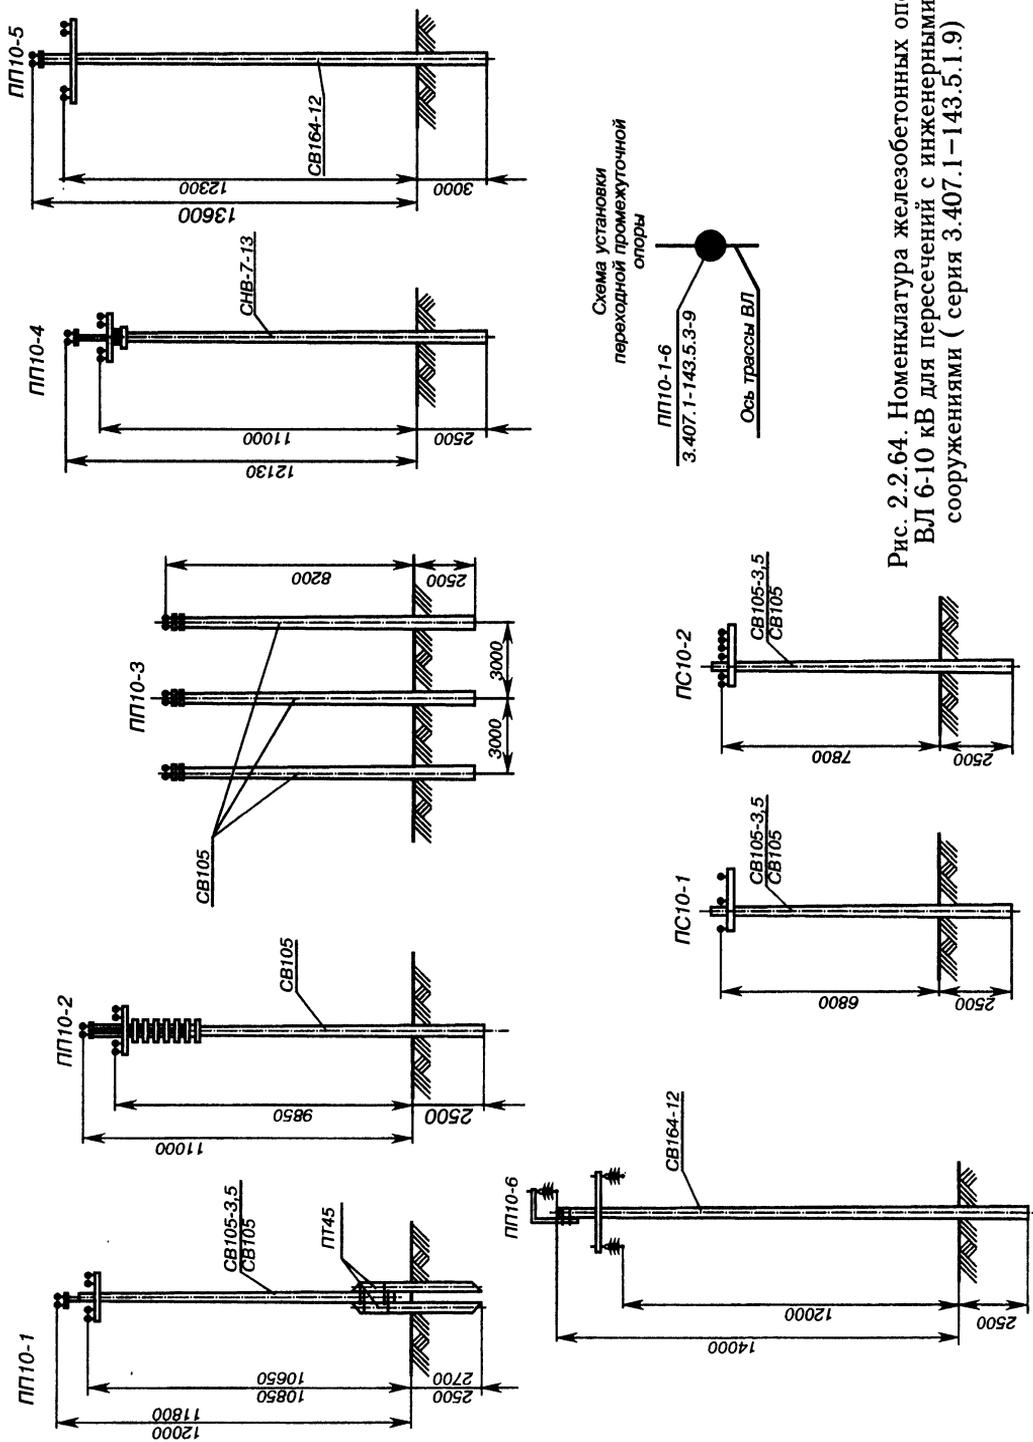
Номенклатура железобетонных опор ВЛ 6-10 кВ для пересечений с инженерными сооружениями (серия 3.407.1-143.5.1.9)
